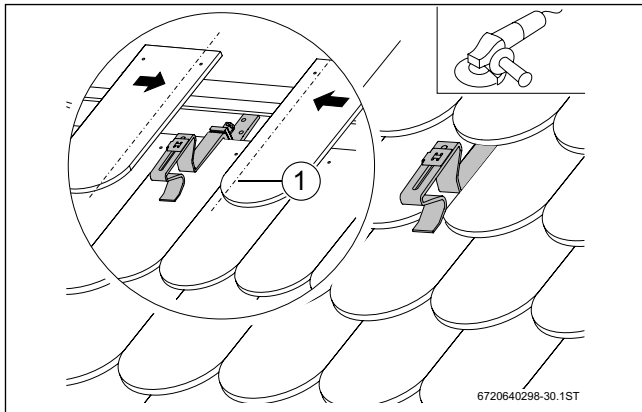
Монтаж кровельного крючка на крыше с покрытием из плоской черепицы
